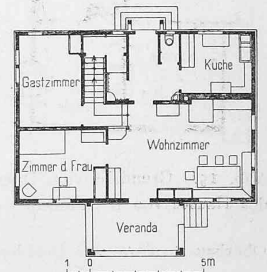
Grundriss vom Erdgeschoss des Sommerhauses «Rotenus». — 1:400.
